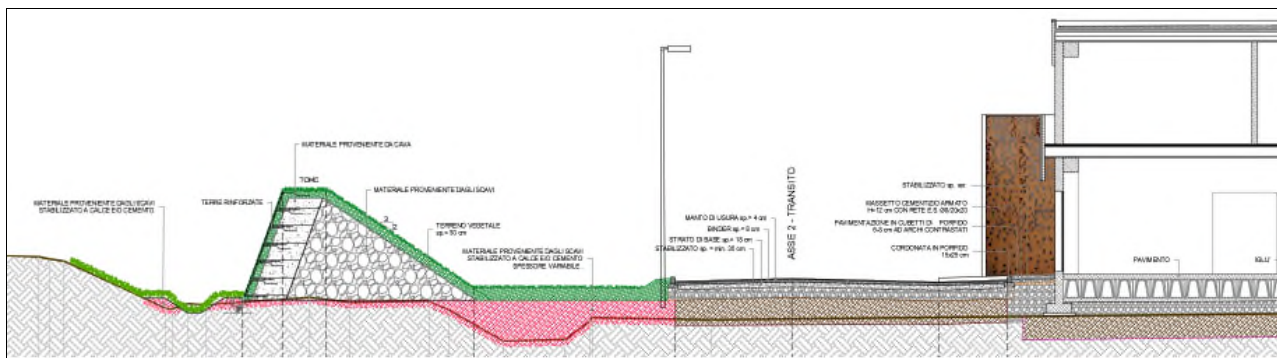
Sezione tipo tratto fabbricato servizi
